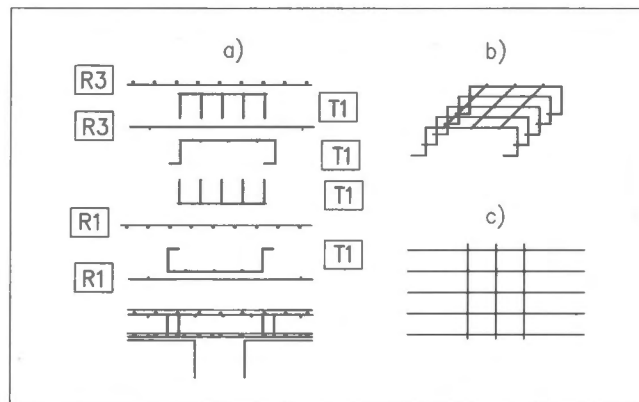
Výztuž rámového styčnicu stěna–strop na stavbě obytného domu v Praze–Vinohradech / Reinforcement of a wall-ceiling frame joint (Residential in Prague–Vinohrady, Czechia)
